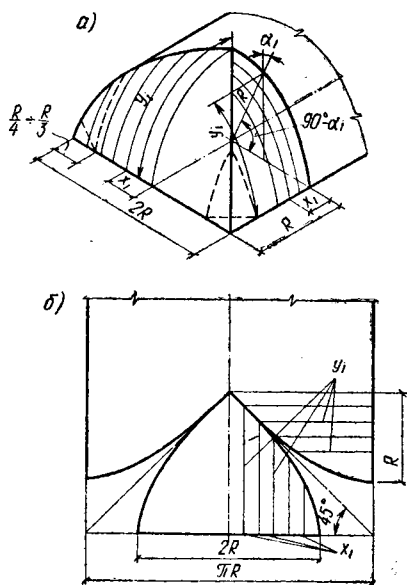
Торце цилиндрической оболочки, образованный пересечением двух цилиндрических поверхностей
